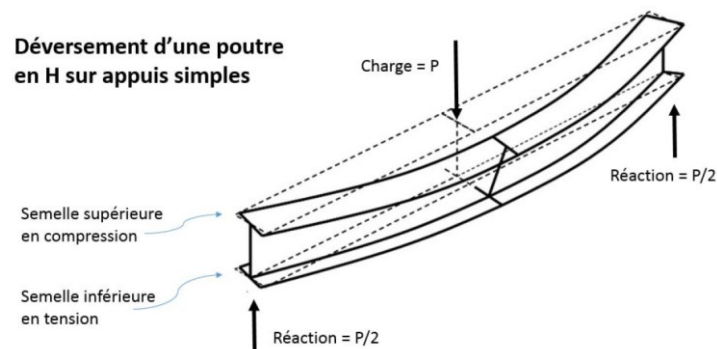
déversement d'une poutre sur deux appuis soumise à une charge transversale engendrant la flexion.
